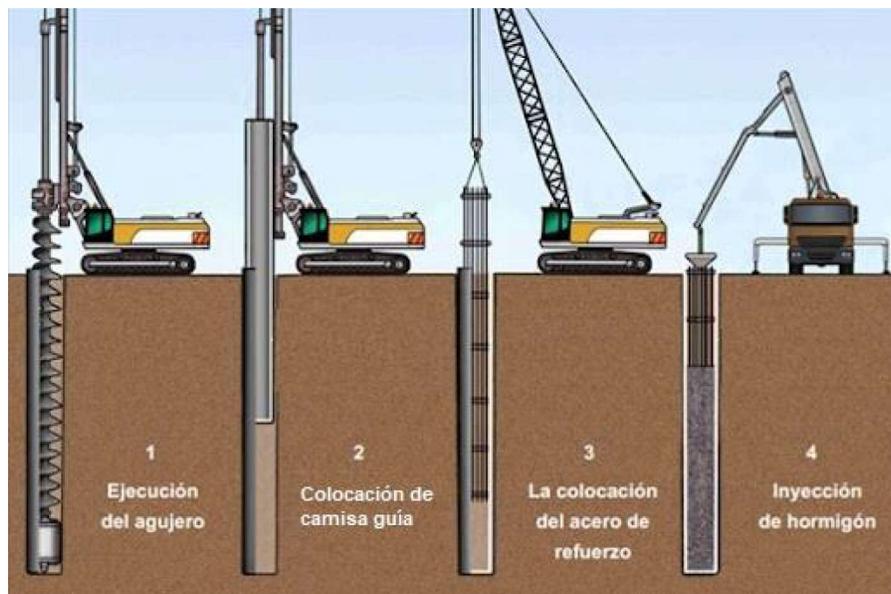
Vista del proceso constructivo para conformación de las pilas.
